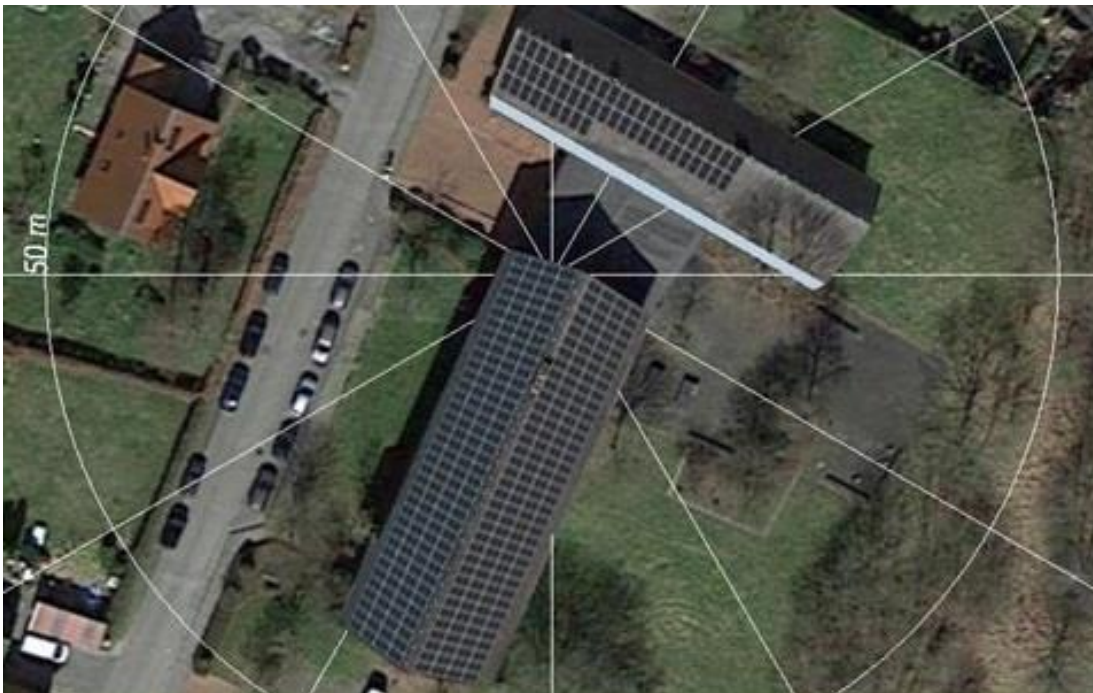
Vorschlag Dachbelegung mit einer PV-Anlage
